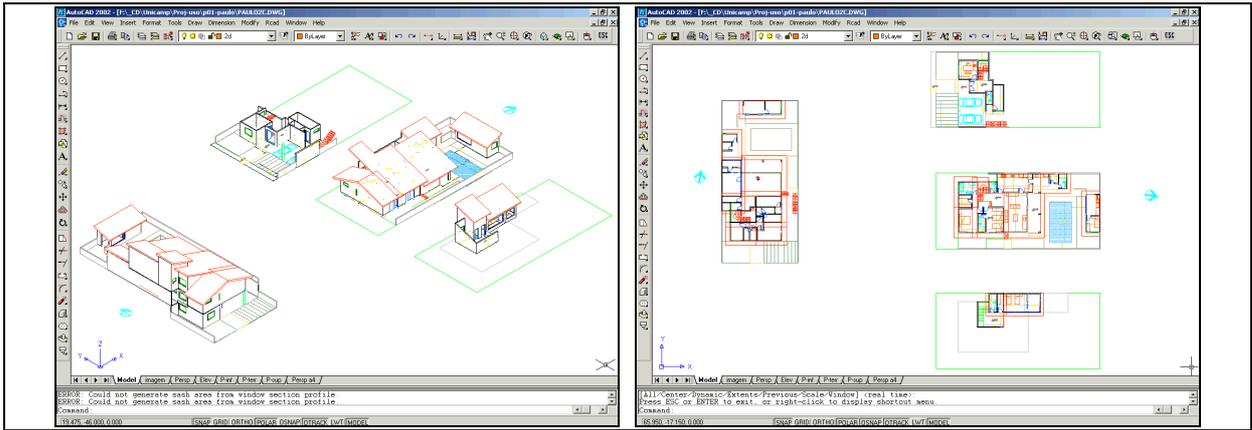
Área de desenvolvimento (model) vista em isométrica e em planta do arquivo do estudo preliminar - Projeto 2 – Panizza
